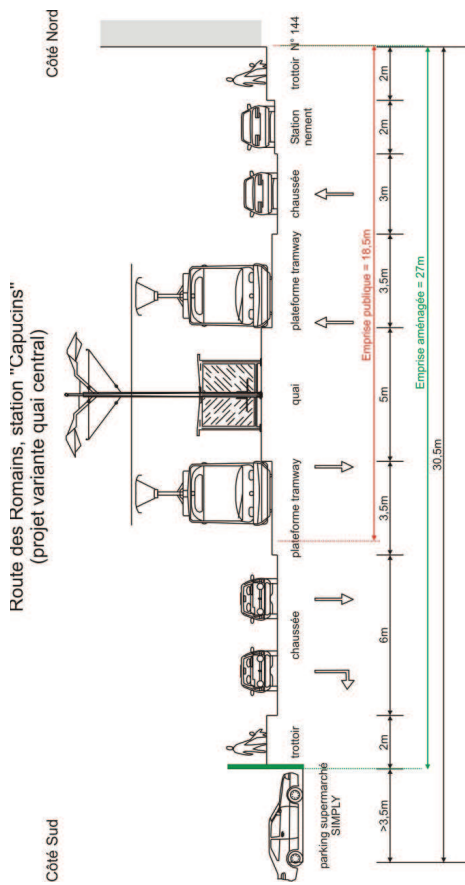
Variante quai central - coupe 35 (route des Romains) station "Capucins"
